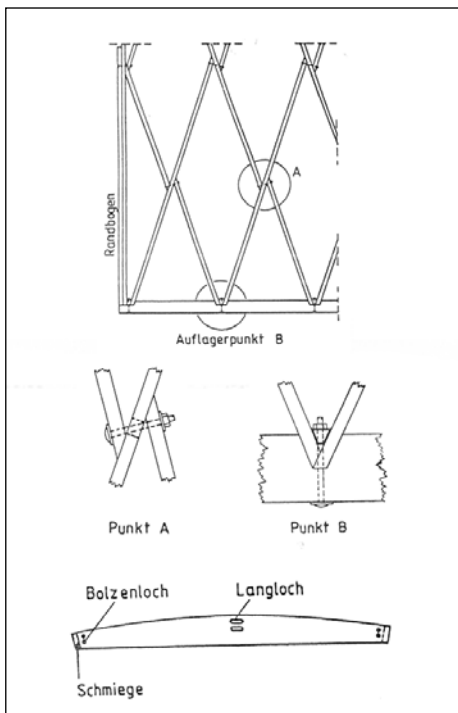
Konstruktionsprinzip des Rauten-Lamellen-Daches nach Zollinger (Erler, Klaus, Alte Holzbauwerke), Schnitt ...
